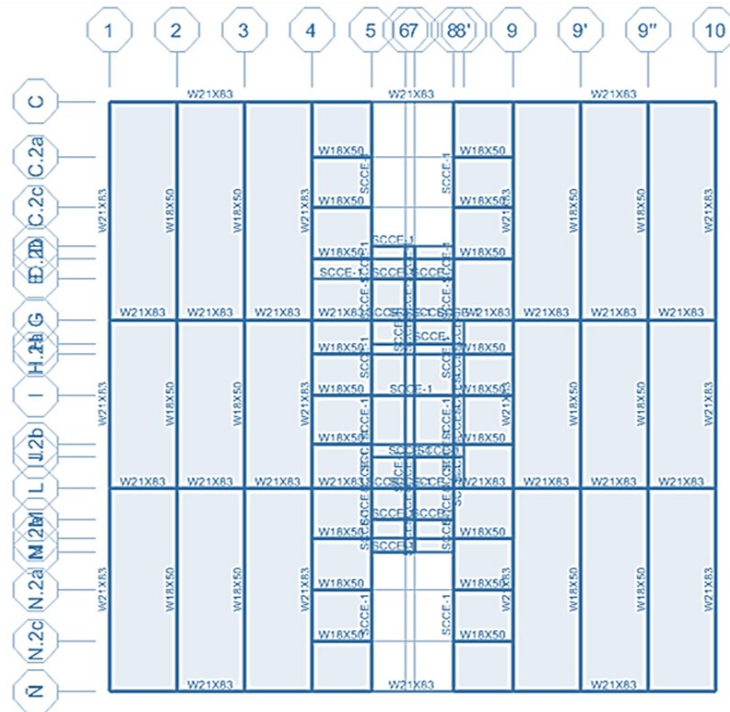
Vista de planta estructural desde piso1 al 4.
